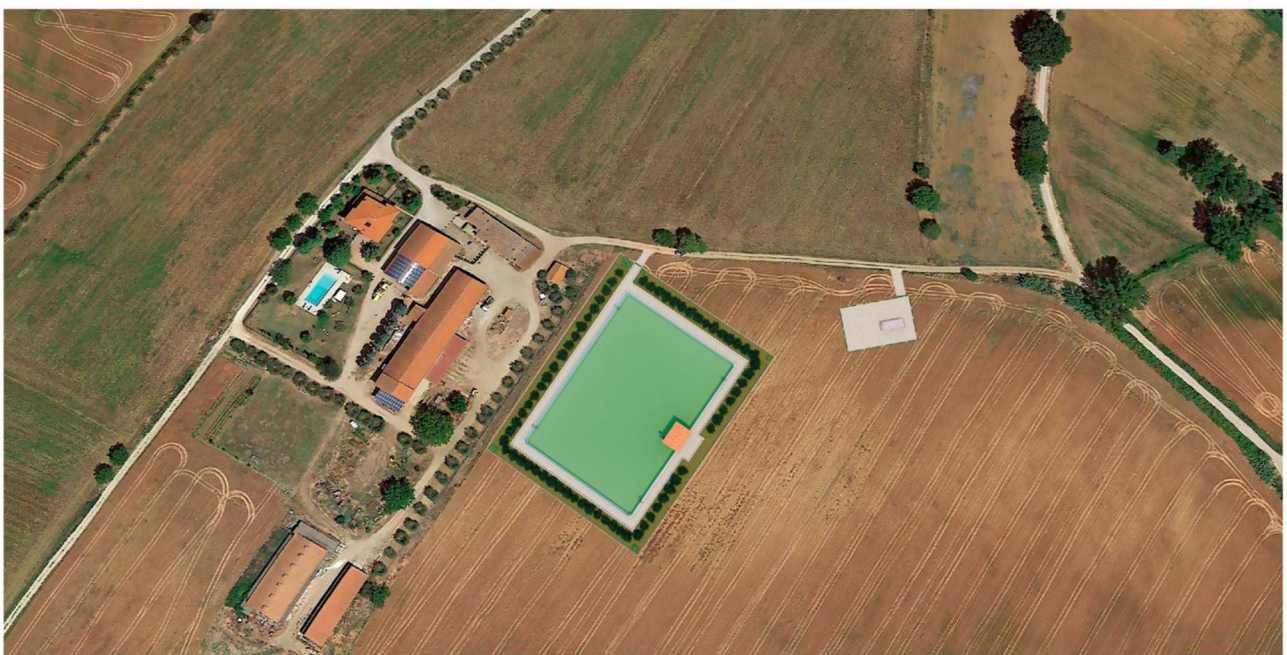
Vista planimetrica Vasca 24+25 – (Render, estratto dalla Relazione paesaggistica)
